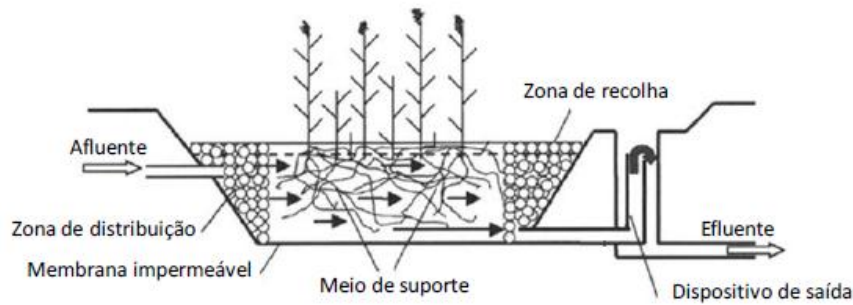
Zona Húmida Construída (Fonte: Botequilha, 2013).
